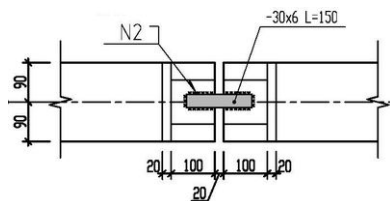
Конструкция расположения узловых пластин на верхних торцах при устройстве вертикального
